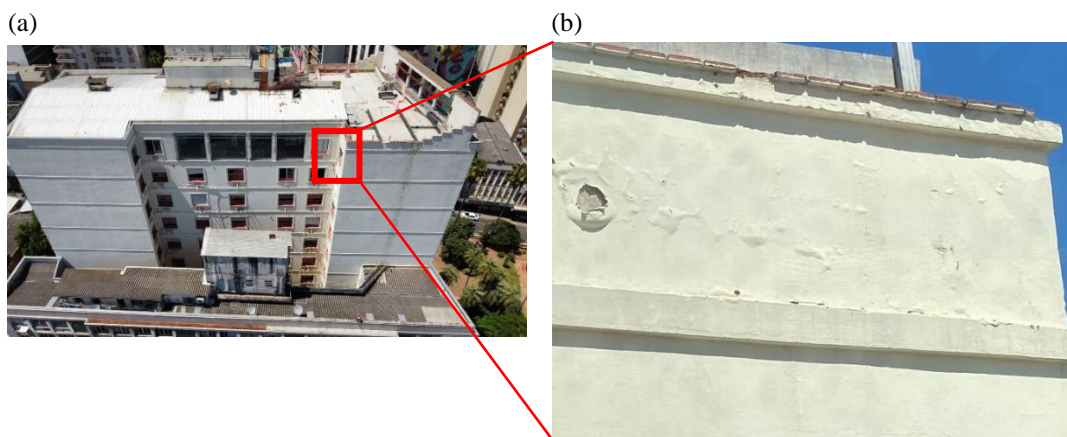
(a) localização e (b) inspeção de manchas existentes na platibanda do pavimento cobertura.
